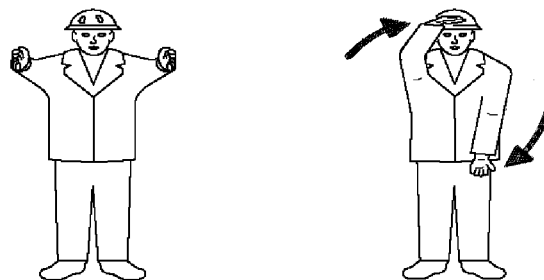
Transferir (entre dois guindastes ou dois ganchos)
